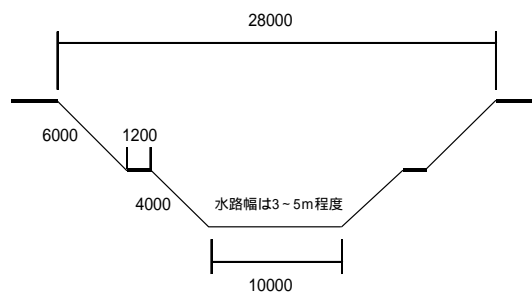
(2) 河川・水路断面図 (地点 笹川)
